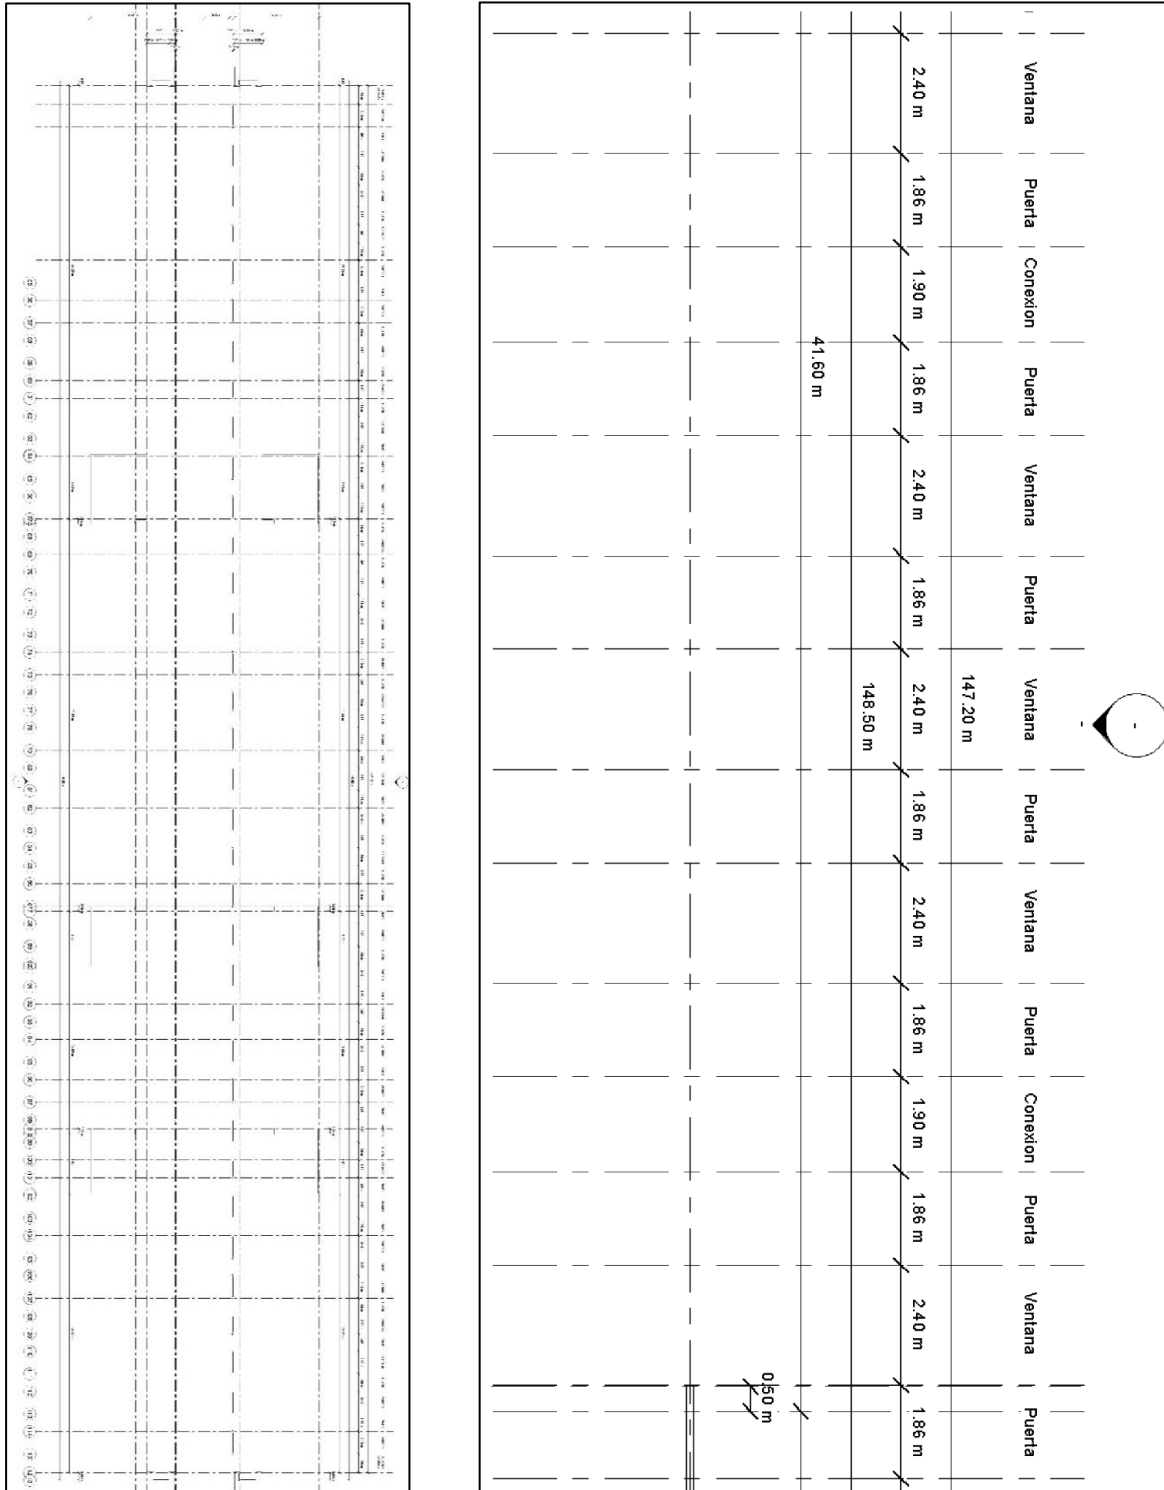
Layout de estación Zócalo con propuesta de seguridad.
